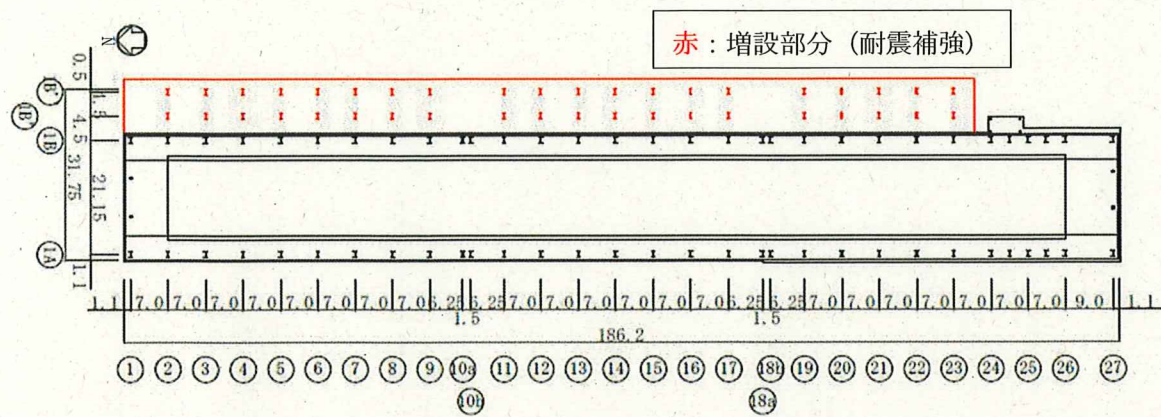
(2) 1階平面図 (G.L. +0.635) (単位 : m)
